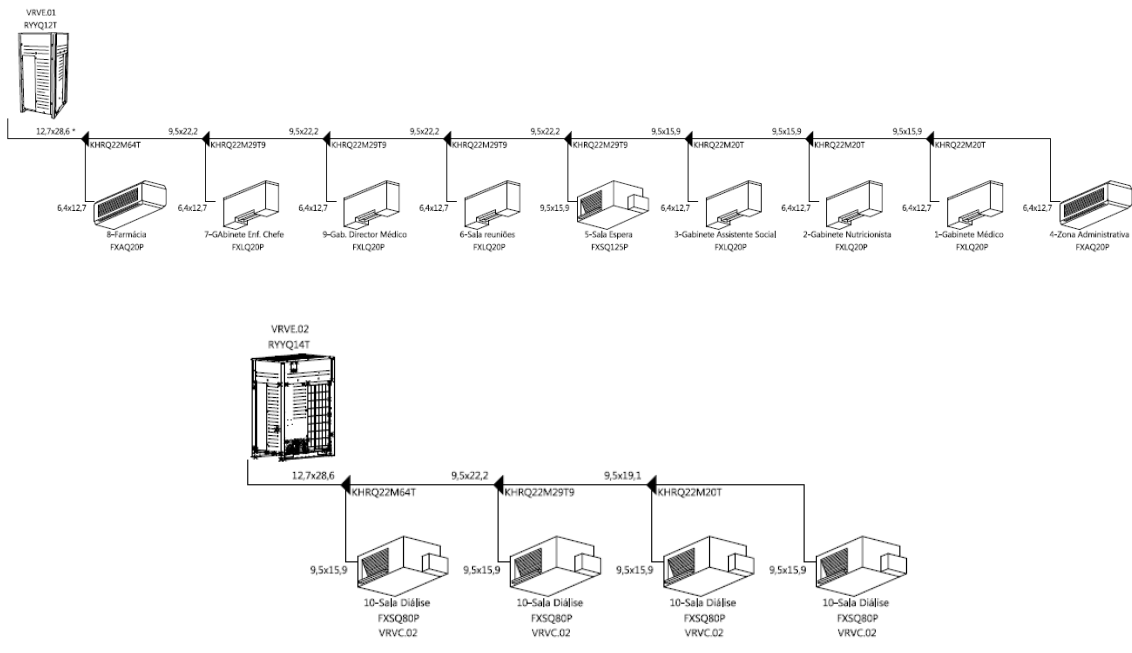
Sistema VRV aplicado em obra (Fonte: Projeto de AVAC)
